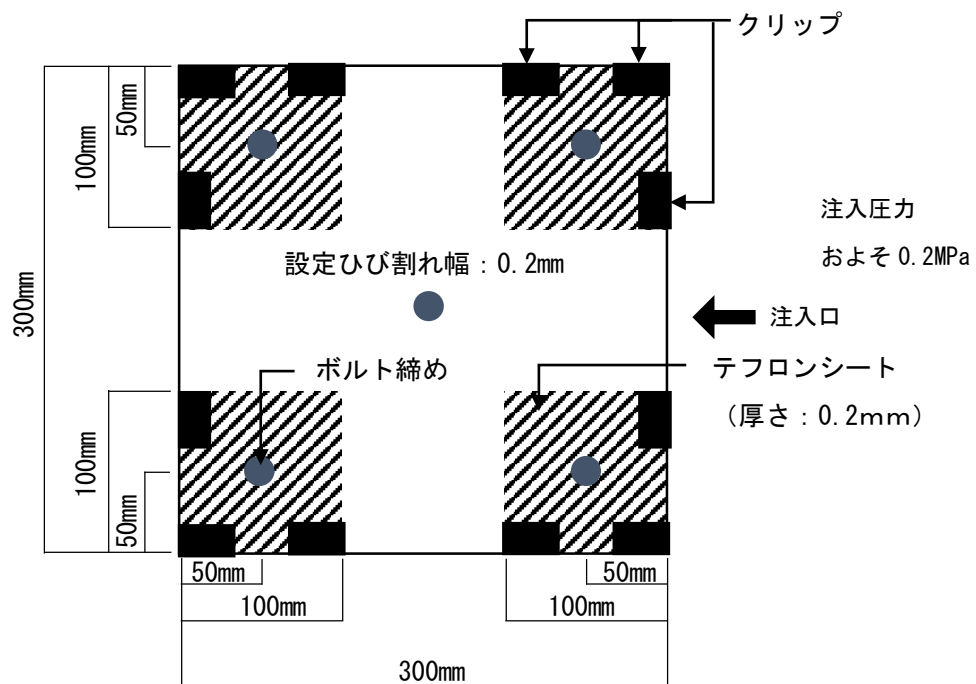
擬似ひび割れ試験体 概要図
